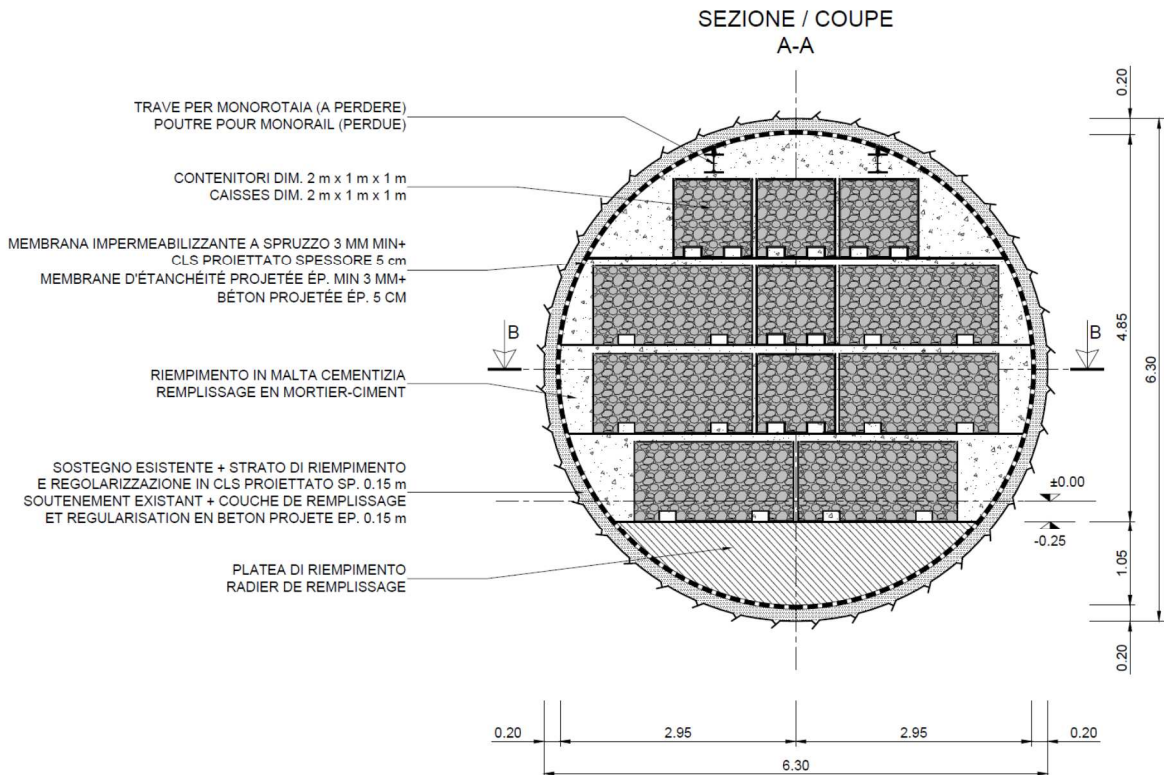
Sezione di stoccaggio nella sezione corrente di Maddalena 1 (PRV_C3A_7526_26-48-10)
